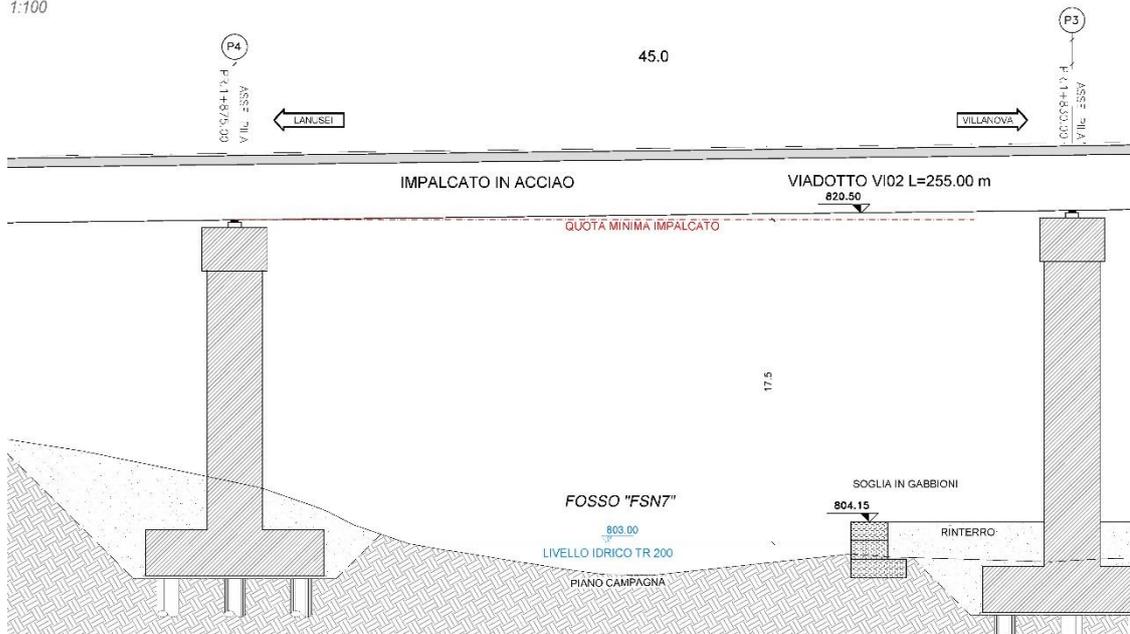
Riu Bacu Gardilis – Sezioni trasversali all’imbocco del ponte.
